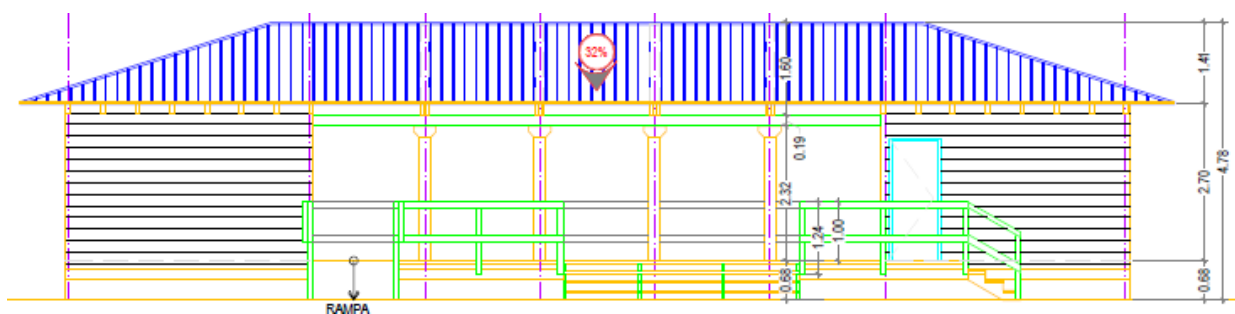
Fachada principal de la cafetería en Los Naranjos, Lago de Yojoa (m)
